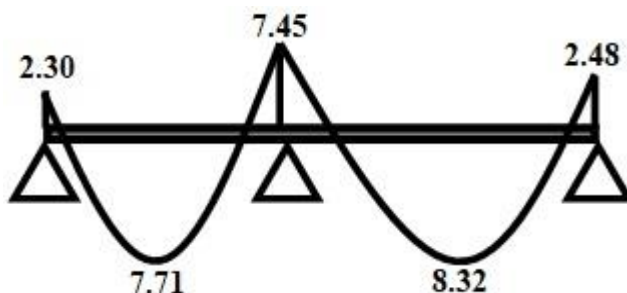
Schéma statique de poutrelle (3<sup>ème</sup> type étage).
